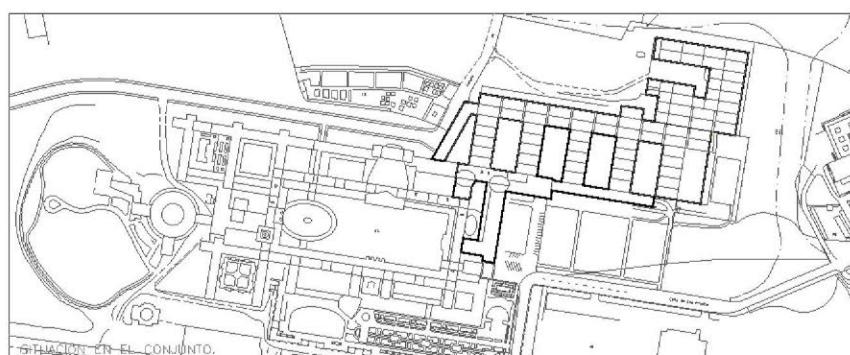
Planta general de la Laboral. Zona de talleres remarcada.
